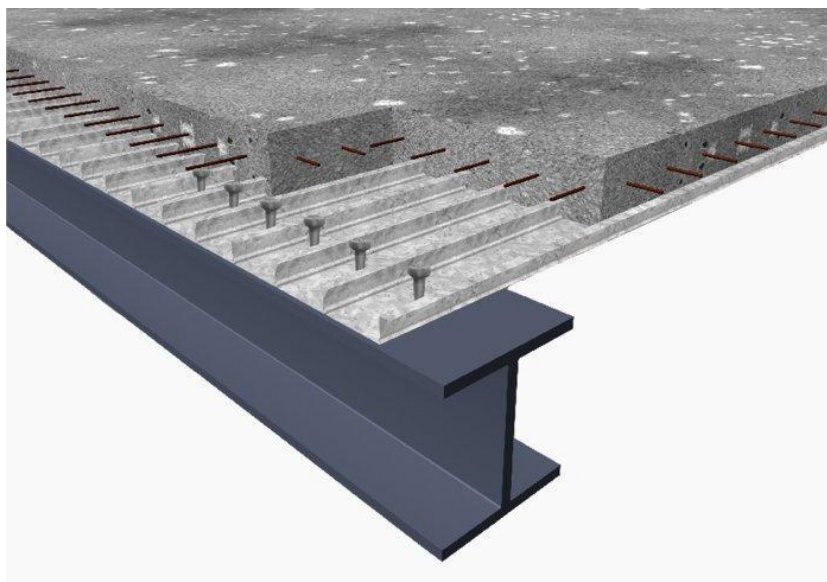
ілюстративне зображення залізобетонного перекриття на сталевих балках
